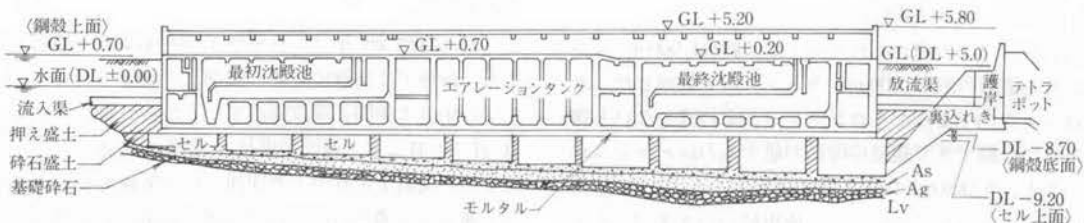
セル基礎、鋼殻ケーソン、下水処理施設縦断面図
